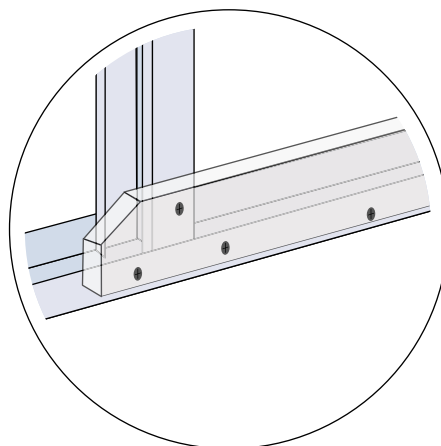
Fixação da placa ao perfil raia e da placa ao perfil montante, separadamente.
